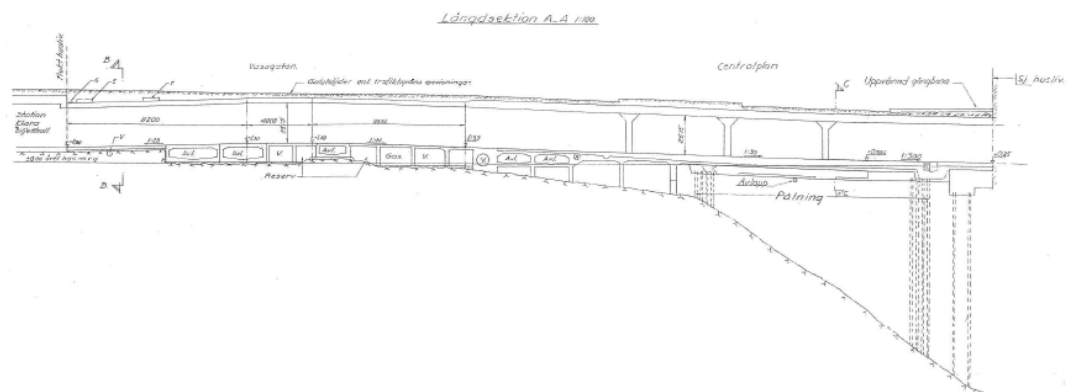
, Gångtunnel mellan Centralstation (till höger) och Tunnelbanans biljetthall (till vänster).
